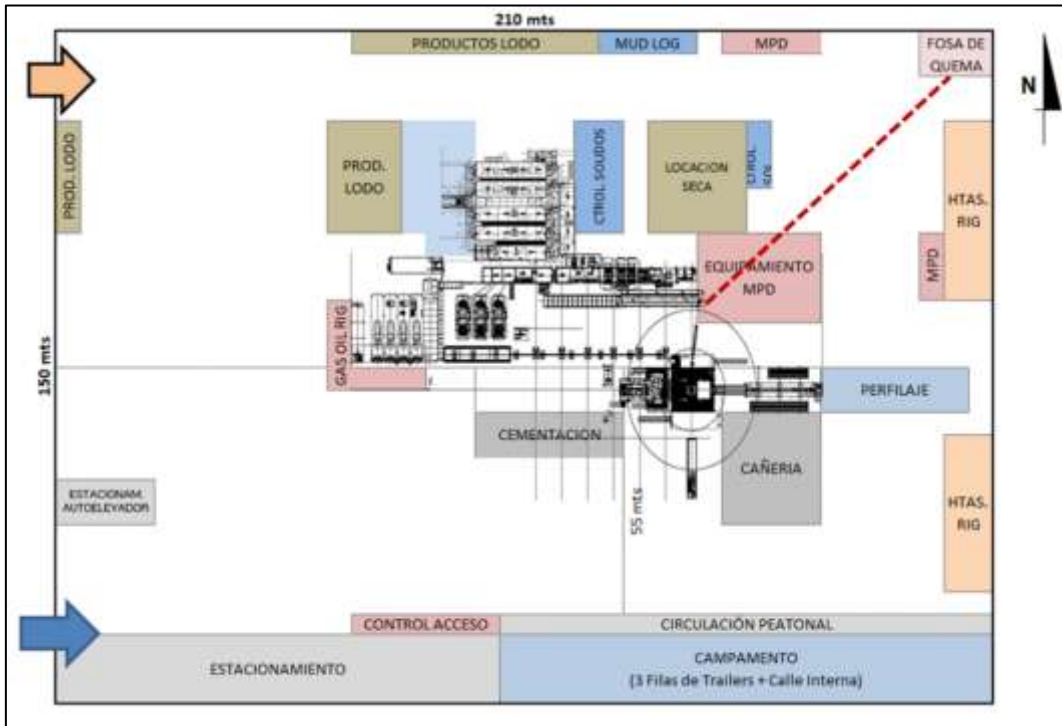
Layout típico de distribución de equipos de perforación en la locación.
